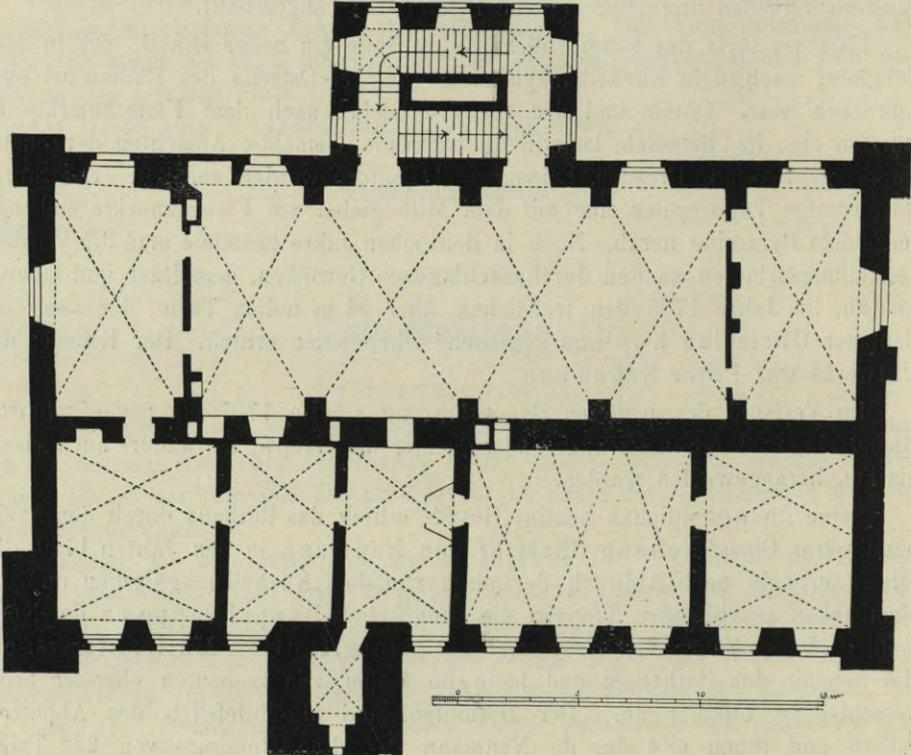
Rathaus, Grundriß des Obergeschosses.
